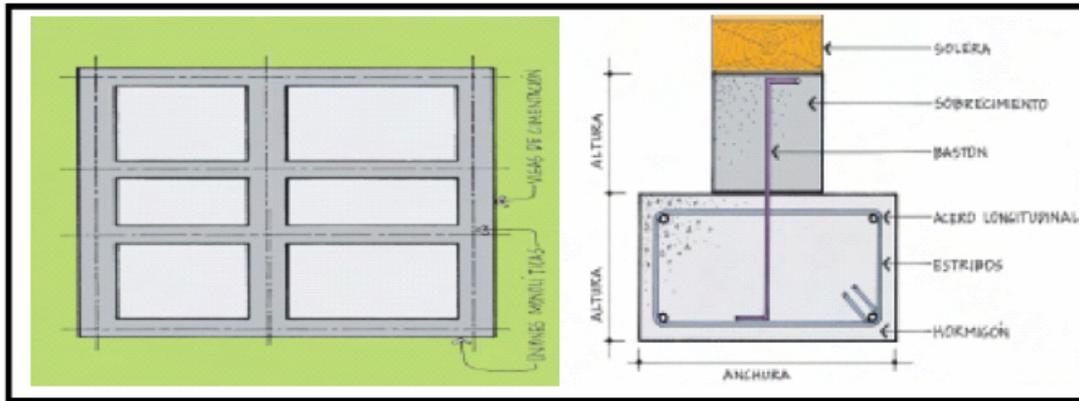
Detalle cimentación. Fuente AIS
